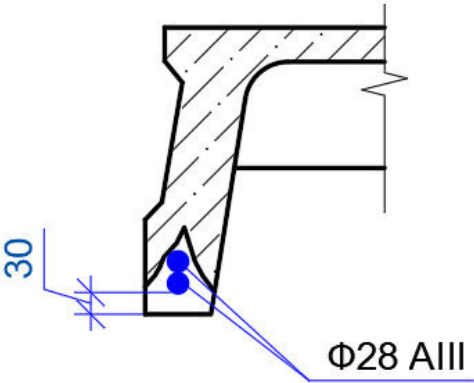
Ребристая плита перекрытия габаритами 1.48x5.55x0.4
